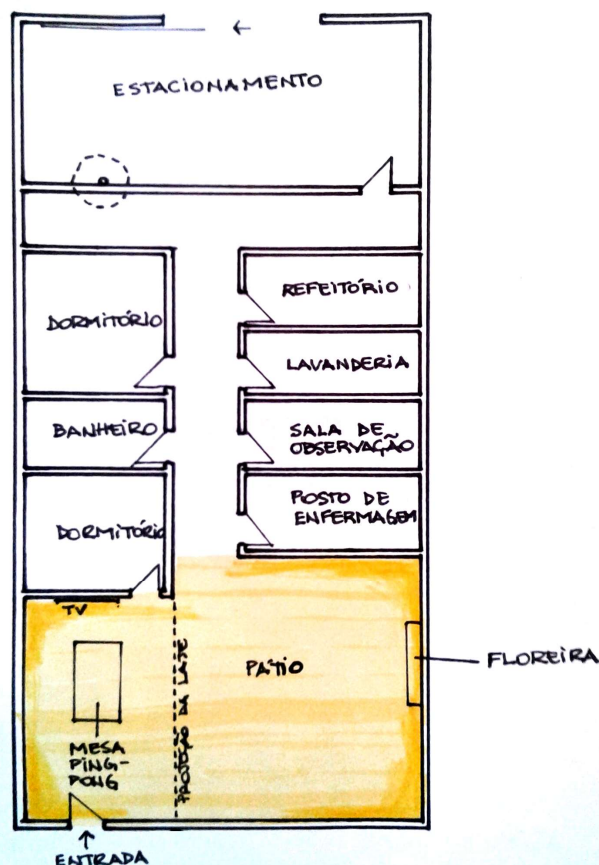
Planta baixa da área do térreo em que os pacientes têm acesso.
